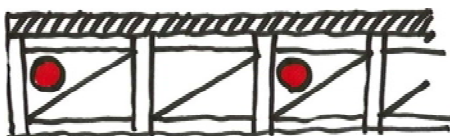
Auflösung der Konstruktion in ein Holzfachwerk
